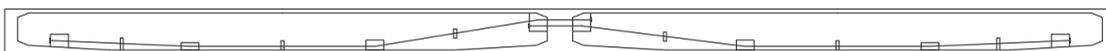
分跨交叉布置体外预应力钢筋示意
